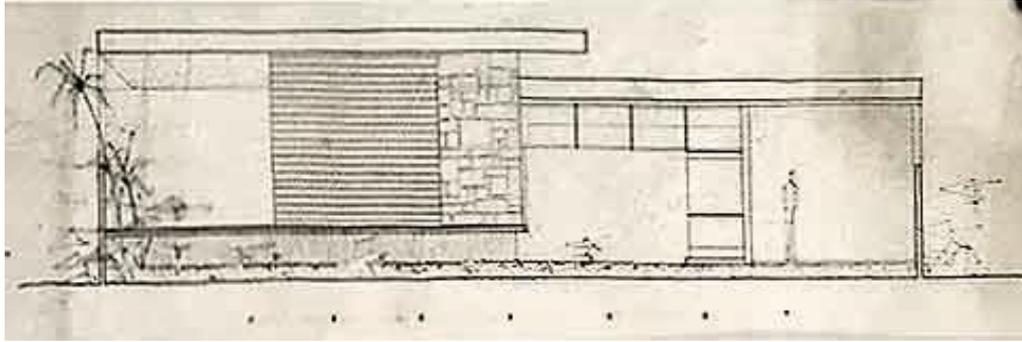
Casa Izabel Almeida, Projeto da Fachada. Fonte: Acervo LAHCA.
